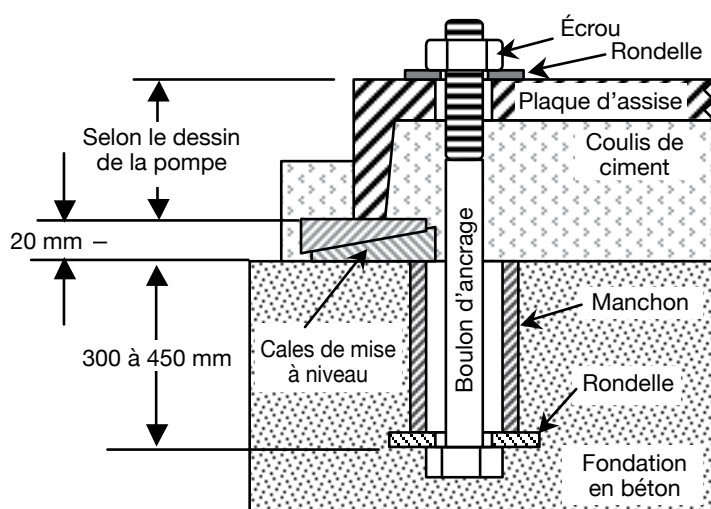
FIGURE A – BOULON D'ANCRAGE TYPIQUE (TYPE MANCHON)
